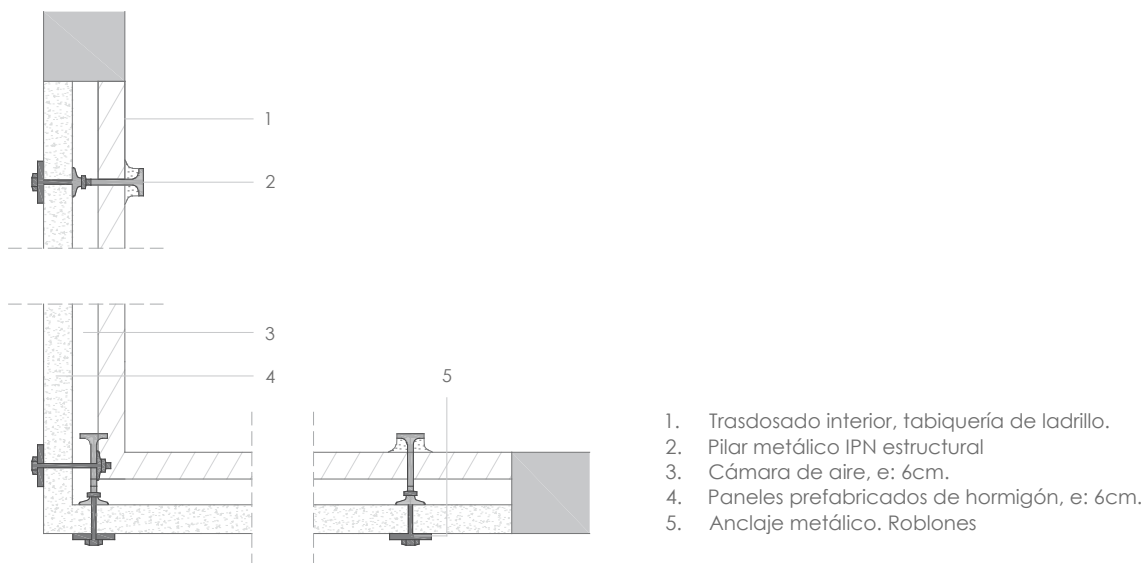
Sistema de anclaje de los paneles al pilar metálico.
